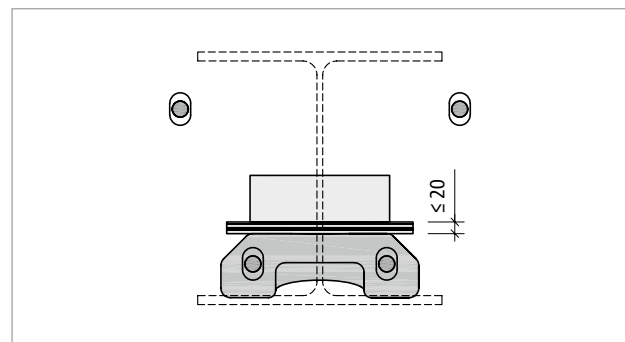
Schöck Isokorb® RT Typ SK: Distanzplättchen auf der Lastaufnahmeplatte erhöhen die Lage des Stahlträgers um bis zu 20 mm
